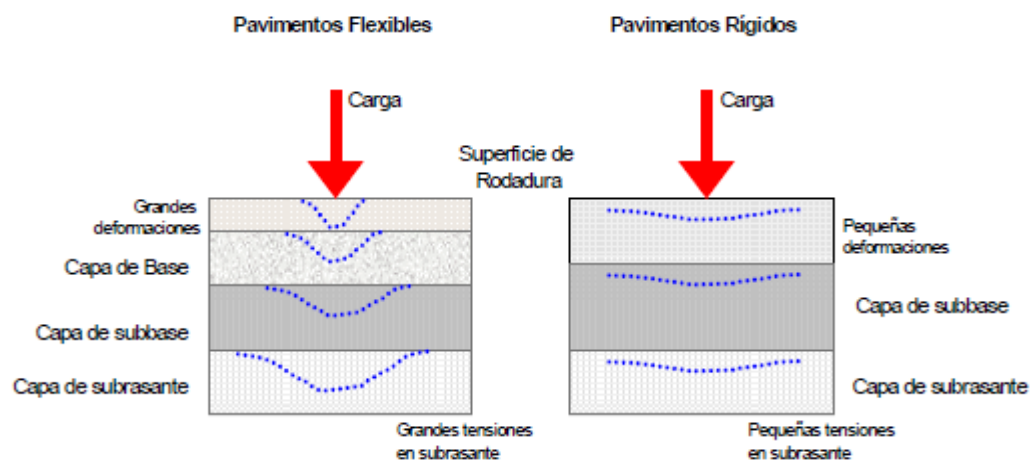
Comportamiento de los Pavimentos Flexibles y Rígidos Fuente: Manual Centroamericano Diseño Pavimentos
